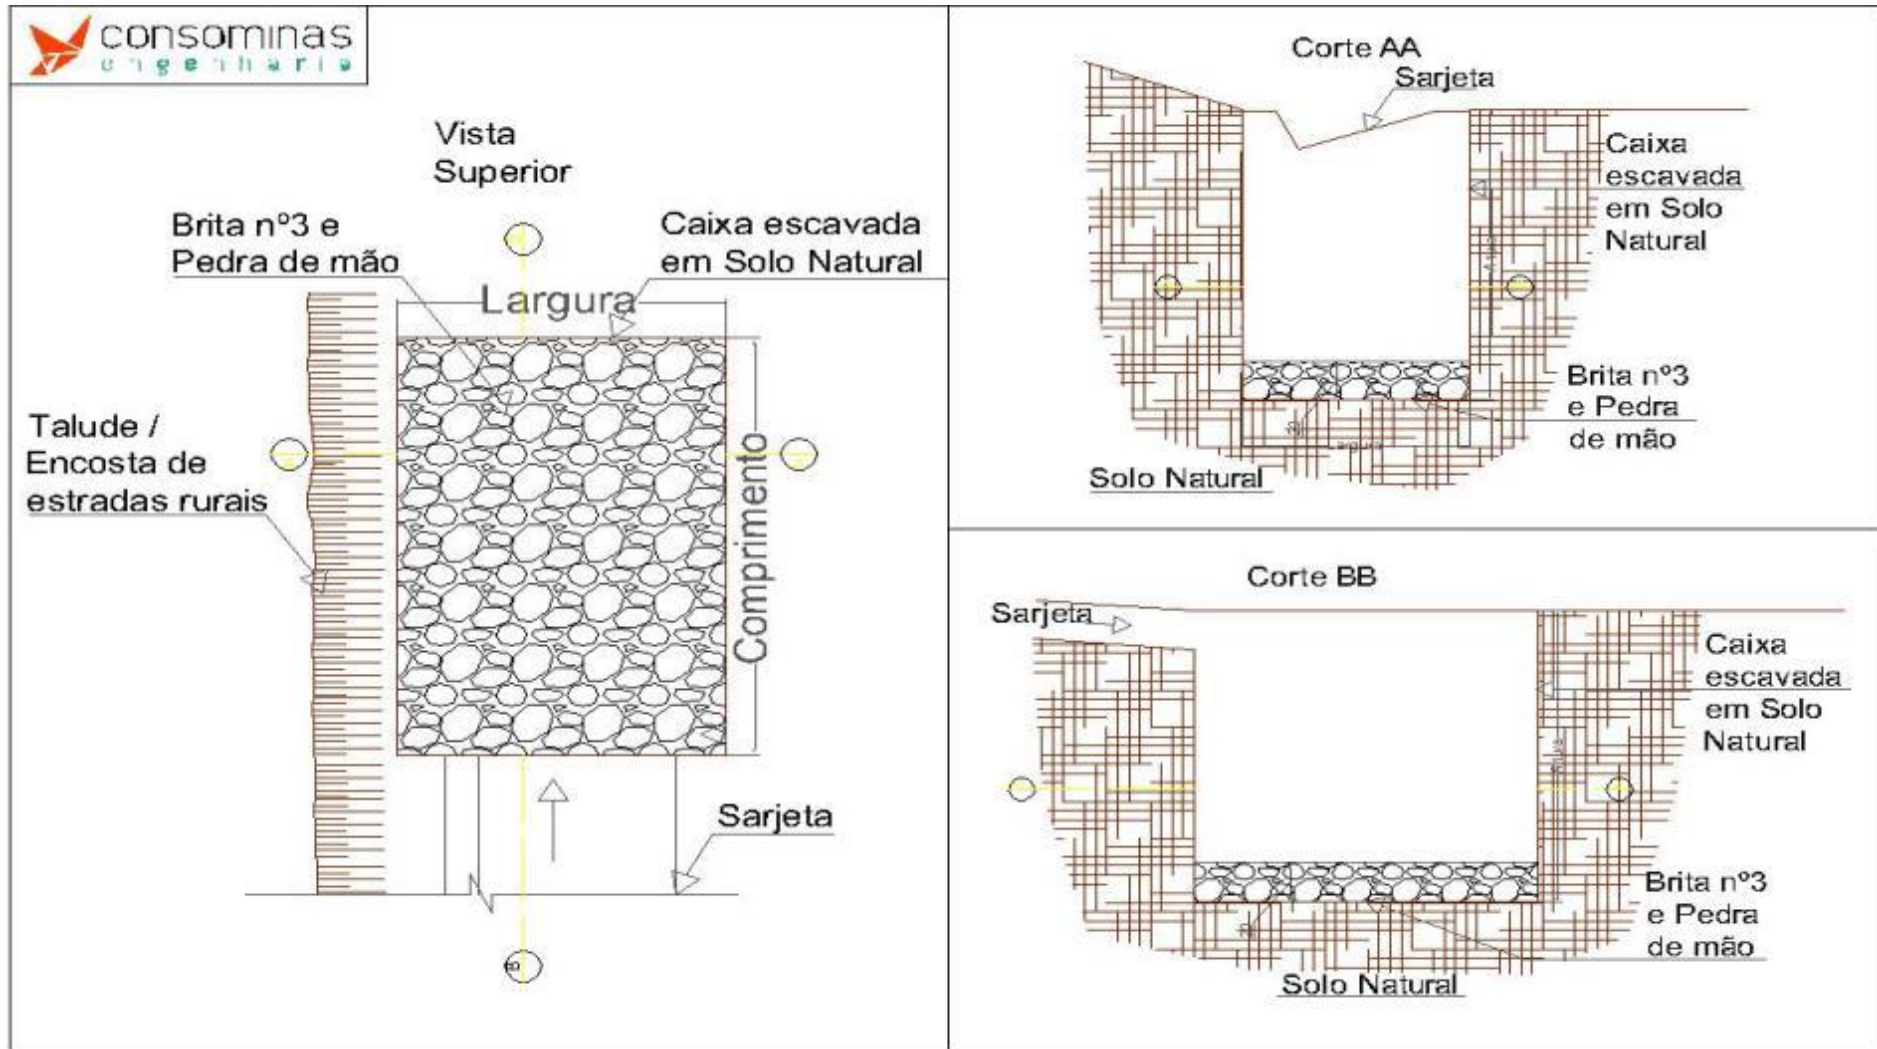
Planta e perfil de caixa de infiltração/dissipação escavada em solo.
